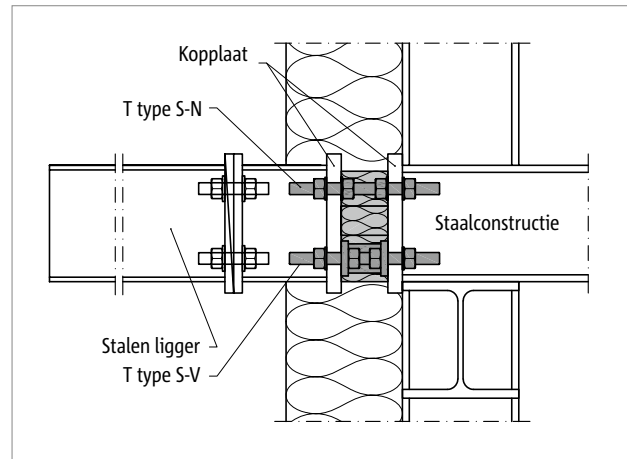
Schöck Isokorb® T type S-V: Ondersteunde staalconstructie
